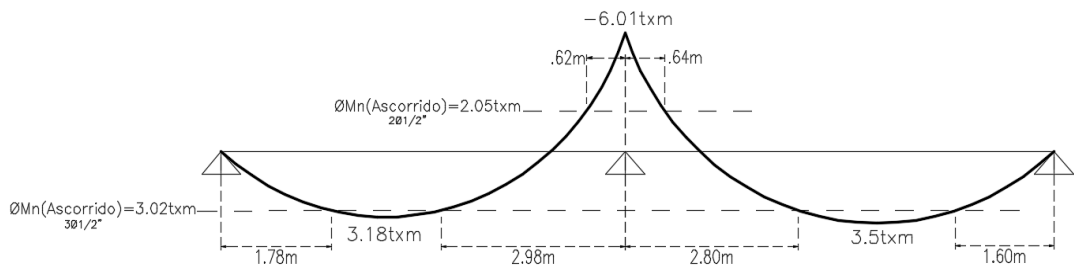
Longitudes teóricas de corte de acero en viga chata VCH-01.
